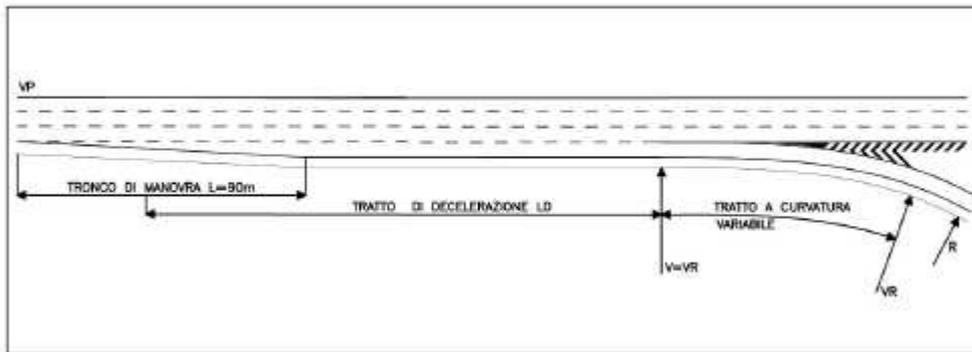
Schema planimetrico corsia di diversione - tipologia parallela
